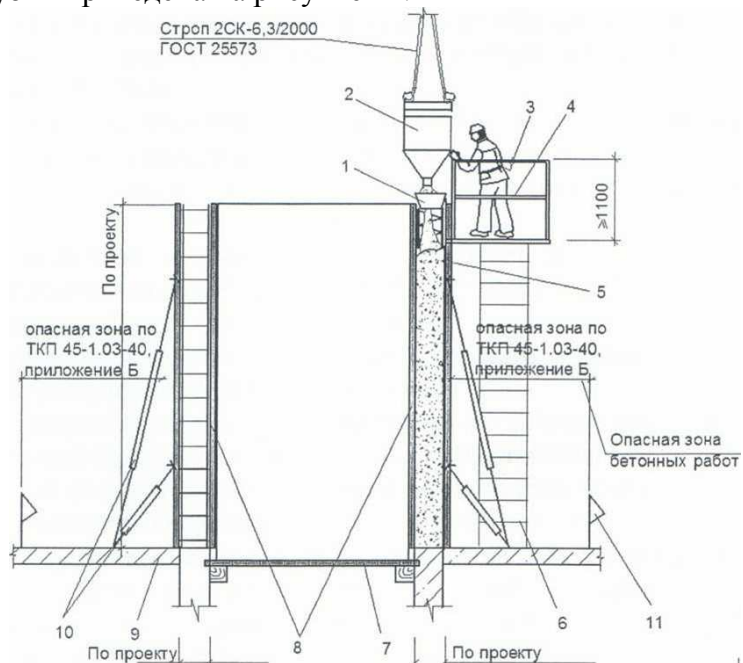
Схема организации рабочих мест по бетонированию конструкций лифтового блока с применением опалубки
